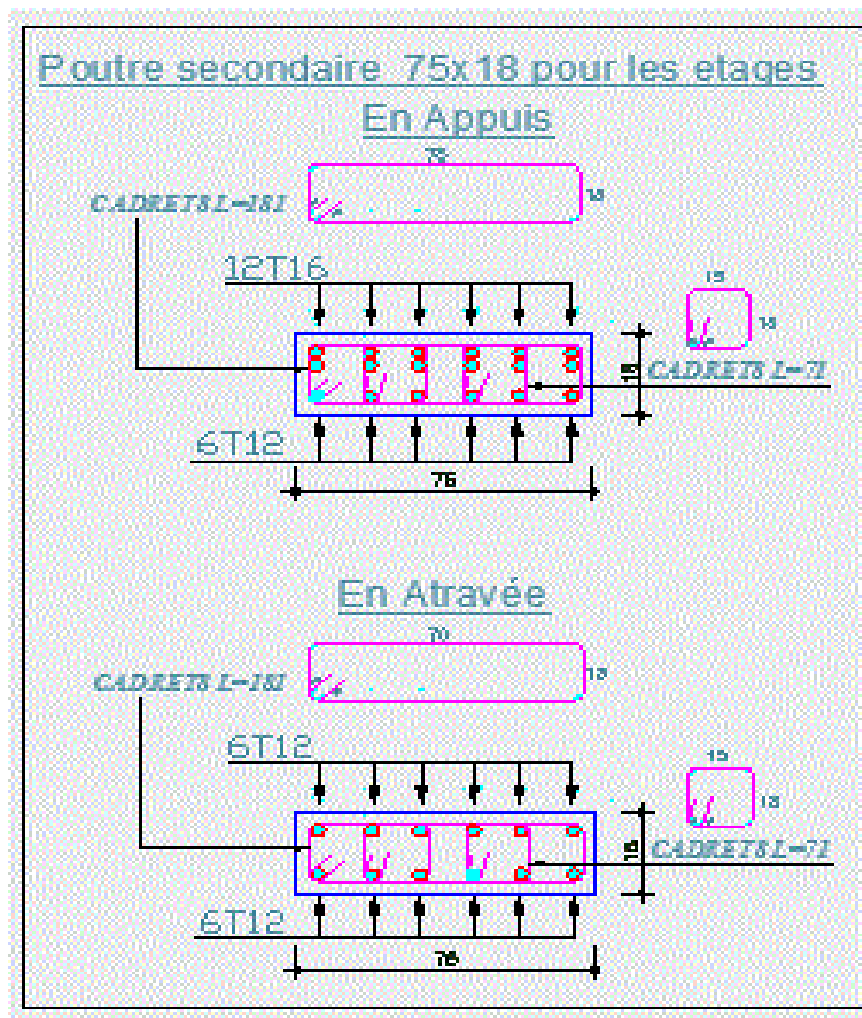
Schéma de ferrailage des poutres secondaire 75x18
